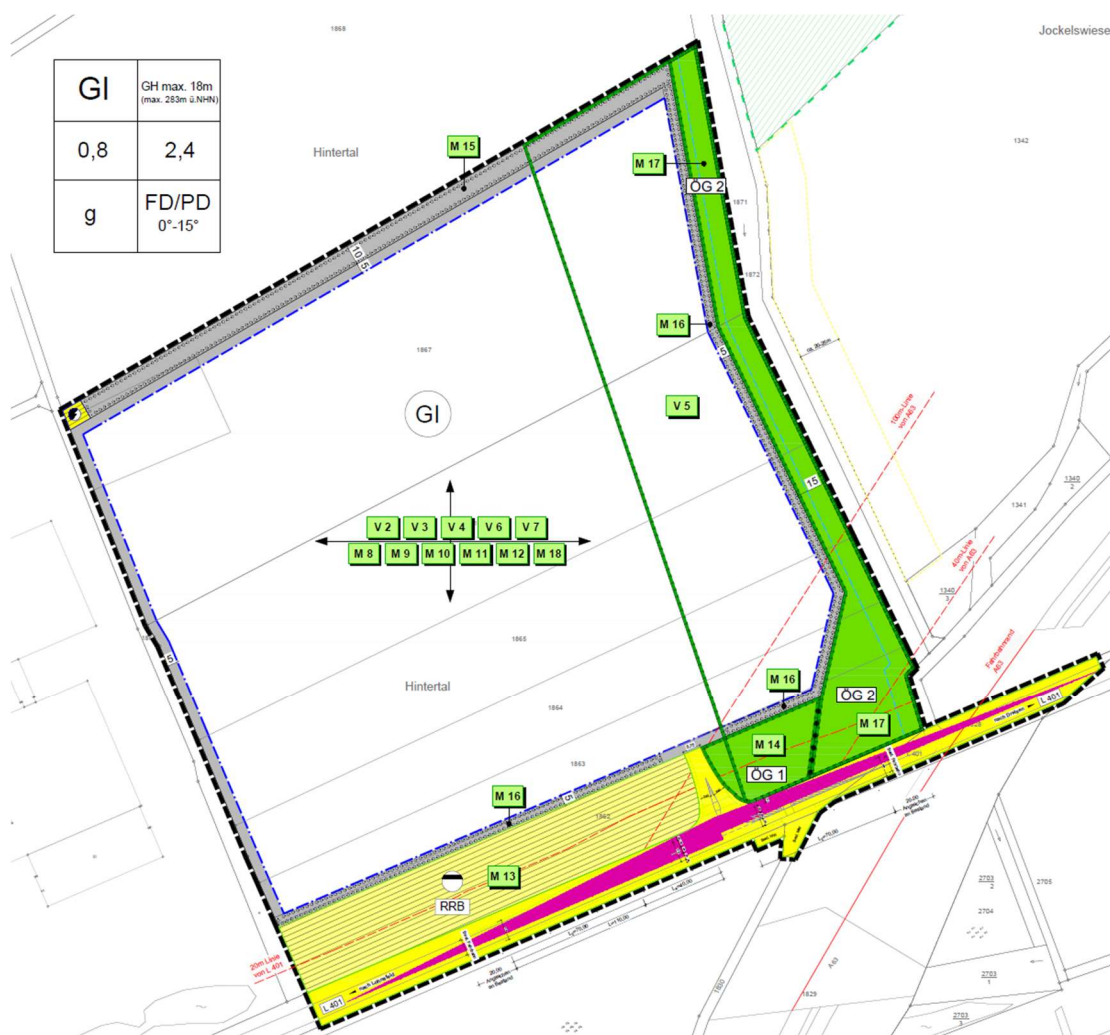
Lageplanausschnitt B-Plan „GI Hintertal“ (Quelle: WVE GmbH Oktober 2024)
